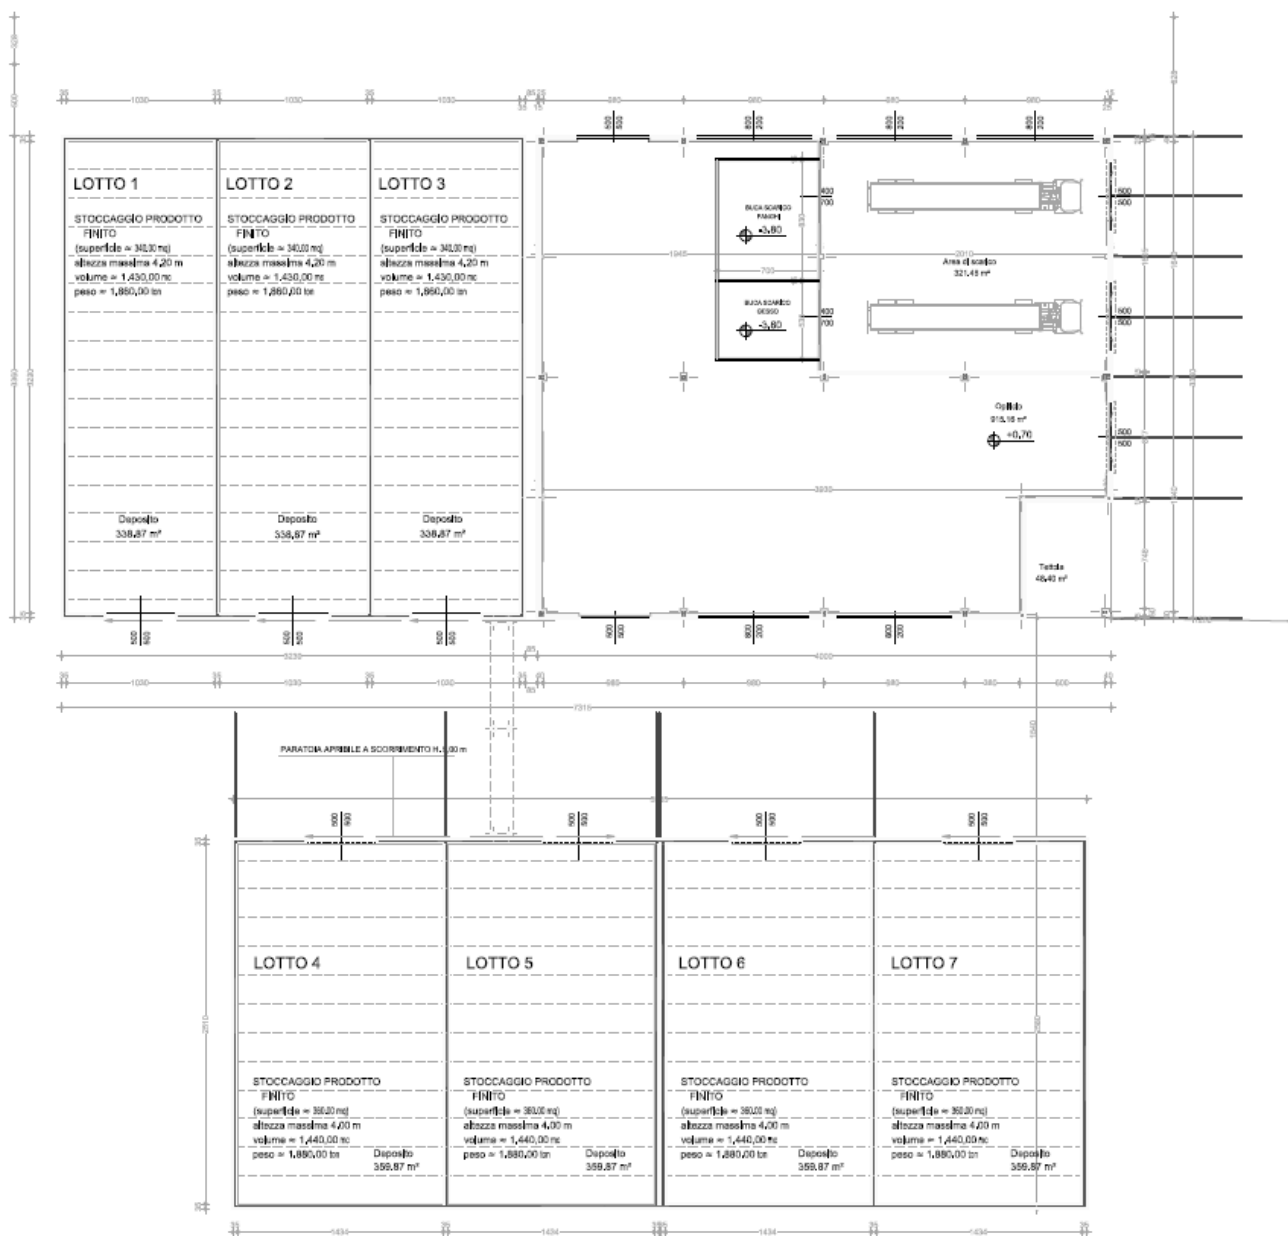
Planimetria trincee di stoccaggio del prodotto finito (lotti 1÷7)
